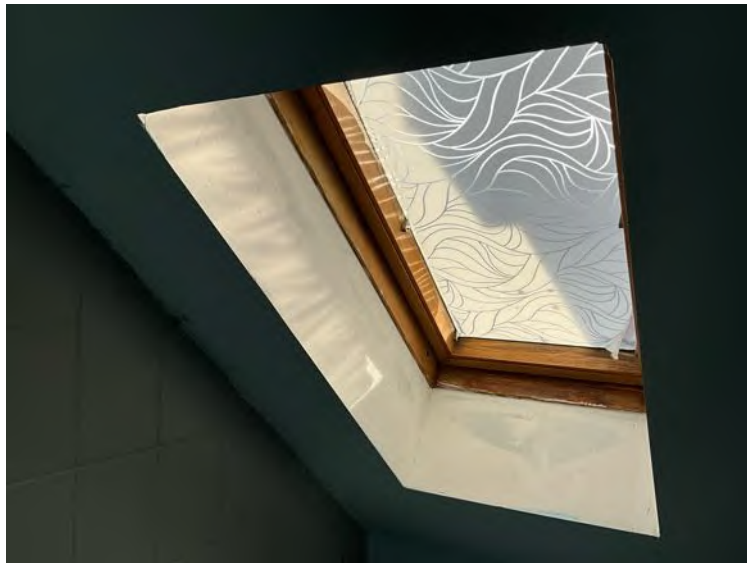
Feuchte- und Substanzschäden im Bereich des Dachflächenfensters
